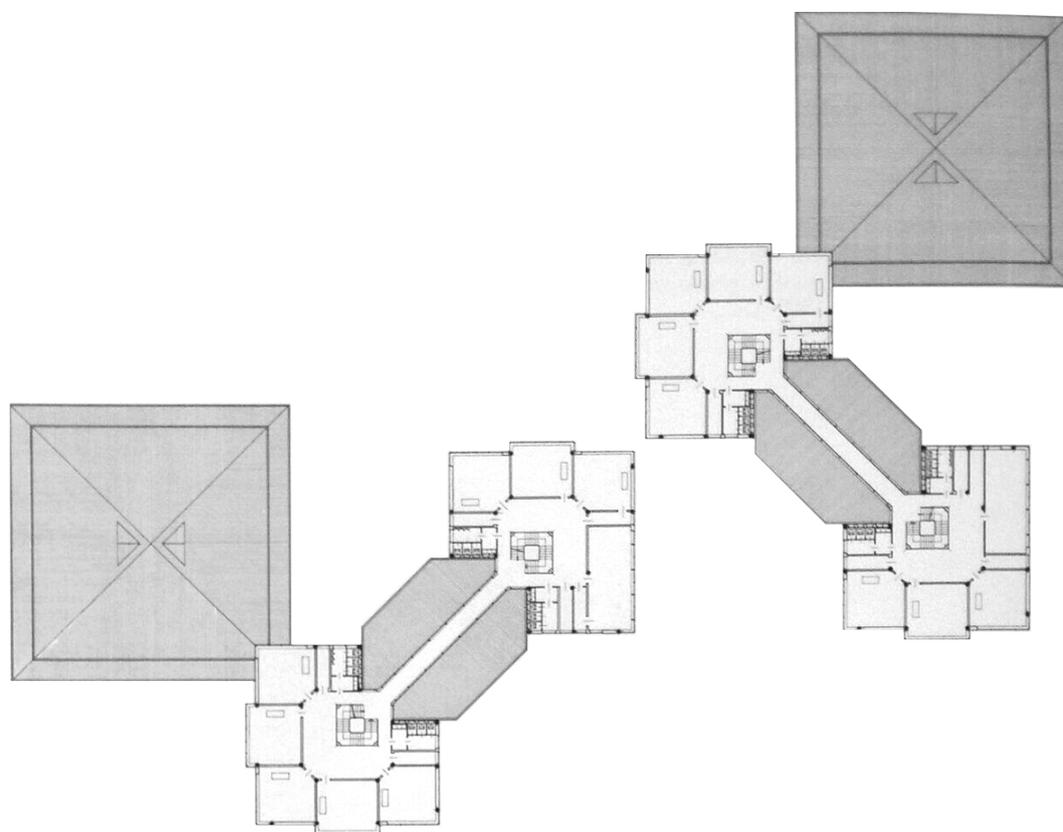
Progetto esecutivo, 1960. Pianta piano primo (fonte: G. Guerra A., Morresi M., Gabetti ed Isola... cit., p. 68).
